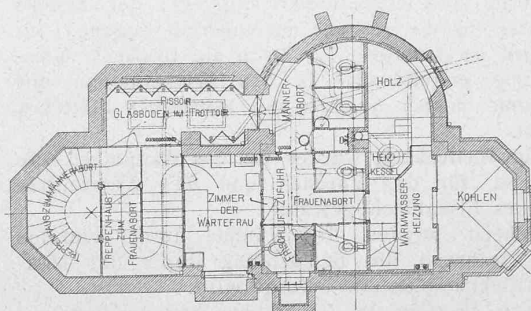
Grundriss vom Kellergeschoss 1:200.
